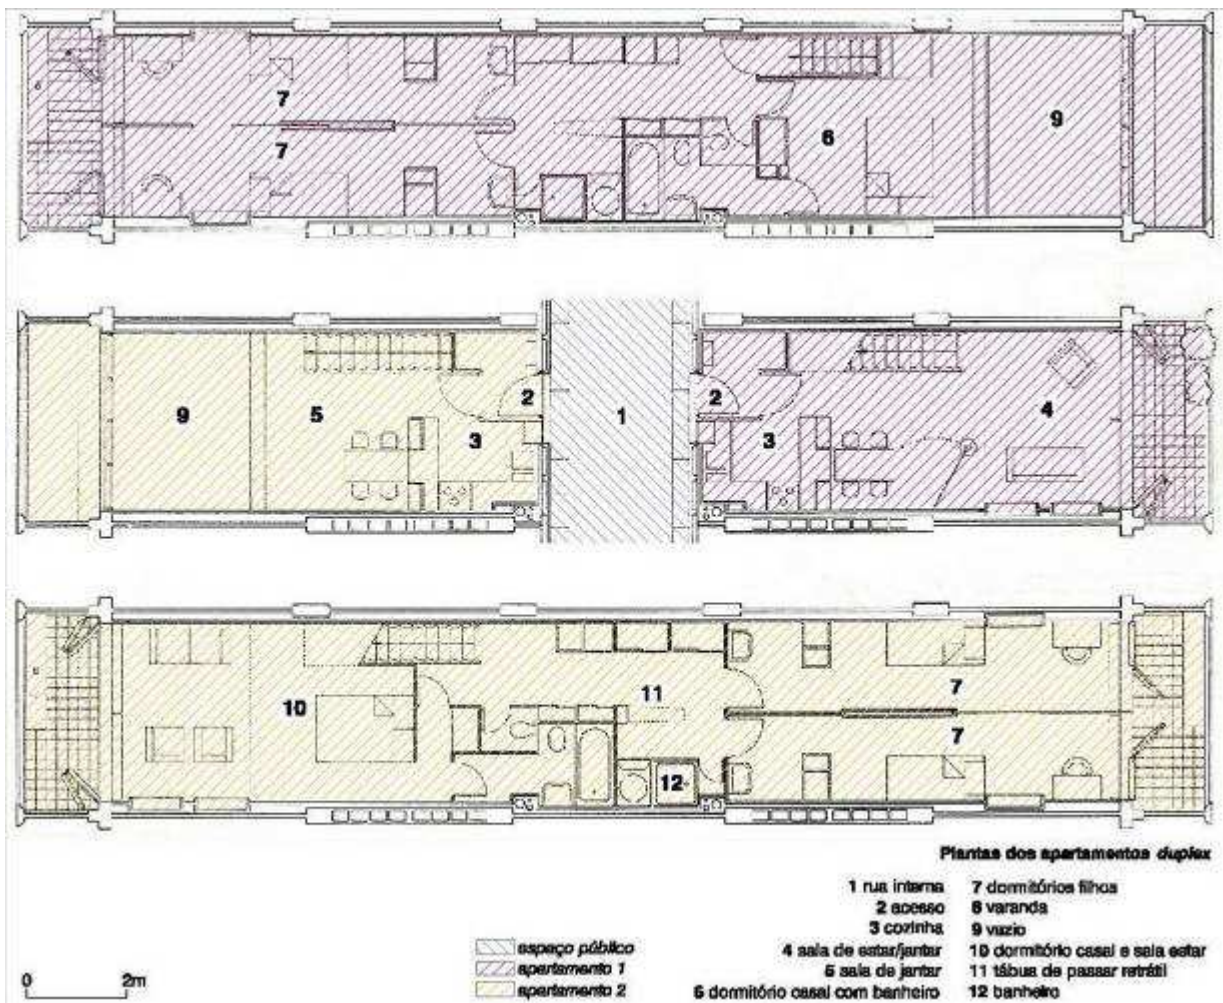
Planta dos apartamentos *duplex* acessados pelos níveis 2, 5, 10, 13 e 16. (FONTE: Adaptado de JENKINS, 1999)
